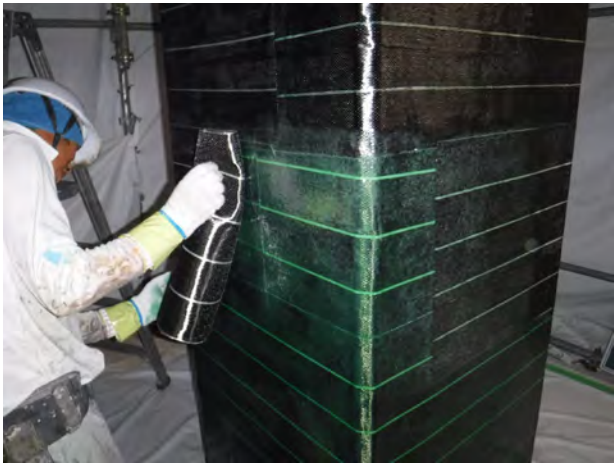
炭素繊維補強状況（地下街駐車場柱 B2F）
